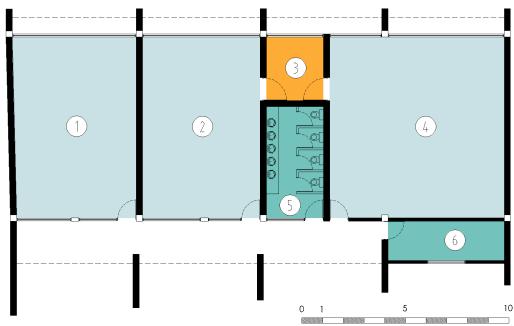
Planta primer piso Bloque No.37 Fuente: Equipo Diagnóstico.
